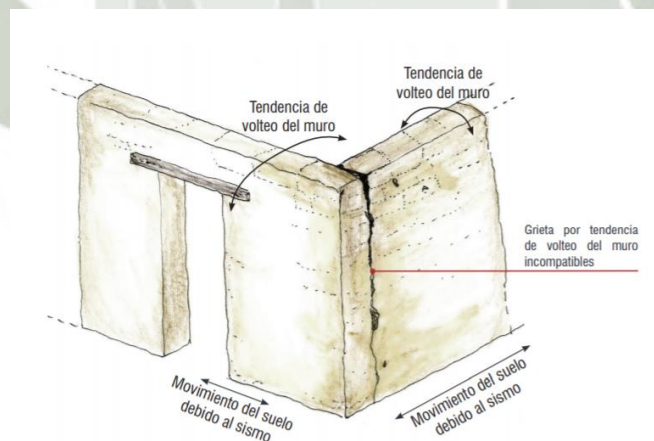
Grieta Vertical en Muros. (\*Fichas para reparación de viviendas de adobe Ministerio de Vivienda, Construcción, y Saneamiento)
